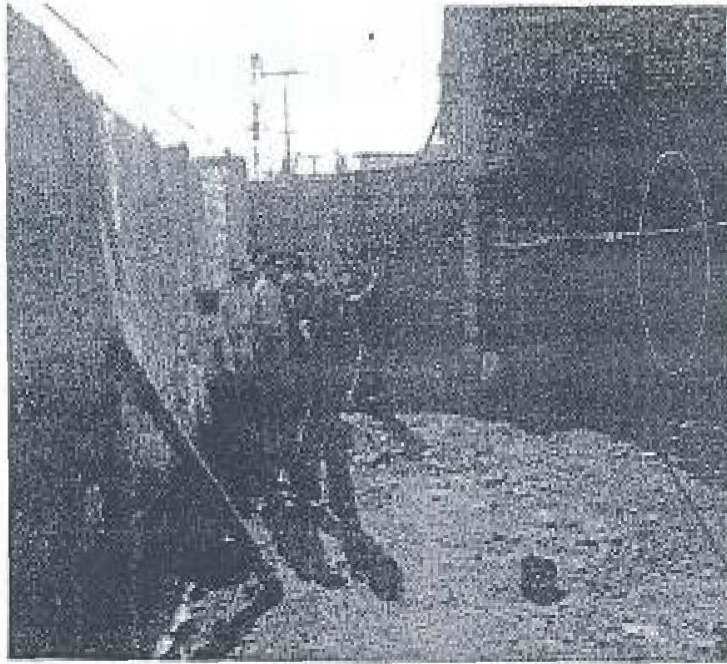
Mismo predio de la Figura 21 en donde se ubica la grieta por la fisura existente.
